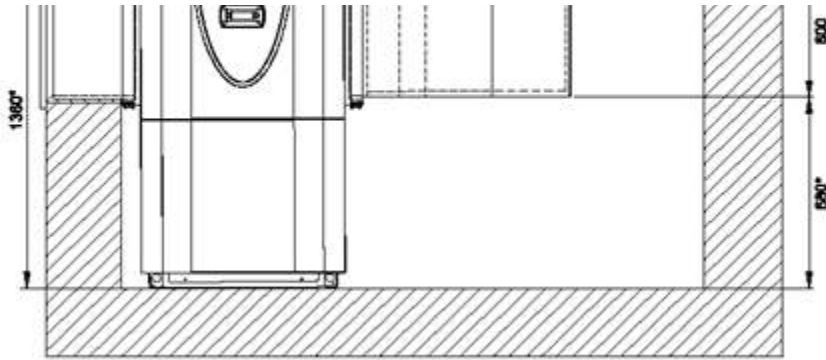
Vue de face - LI 11TES (Installation murale avec gaine d'air côté refoulement)
